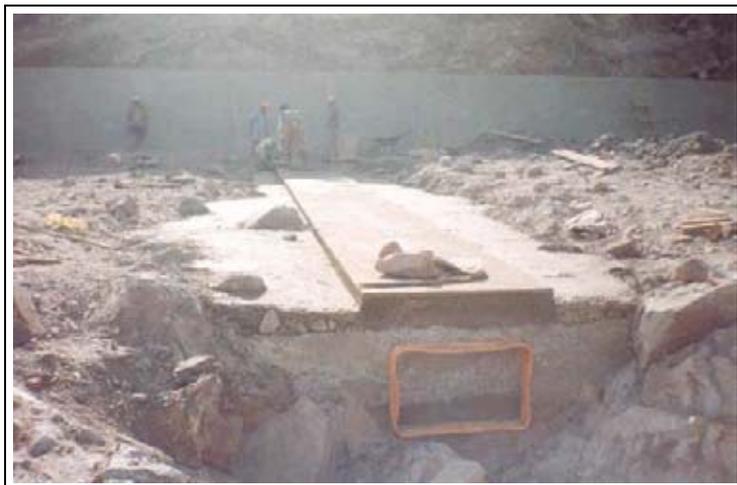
Detalhe da junta Fungemband executada no cordão de fixação.
